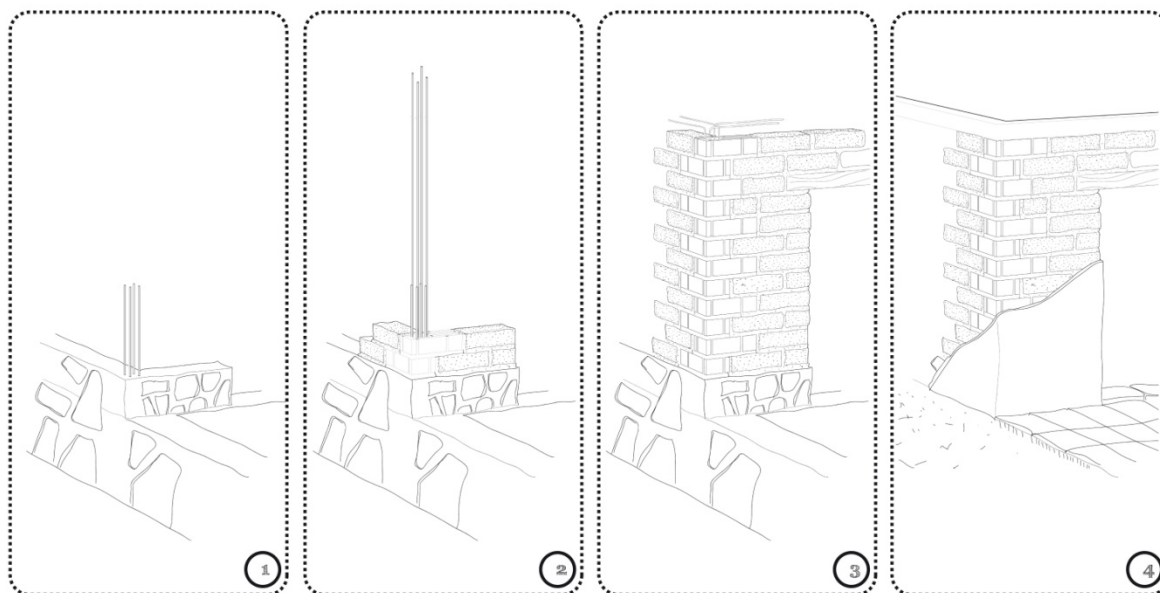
Axonometría del proceso de construcción del detalle en esquina
